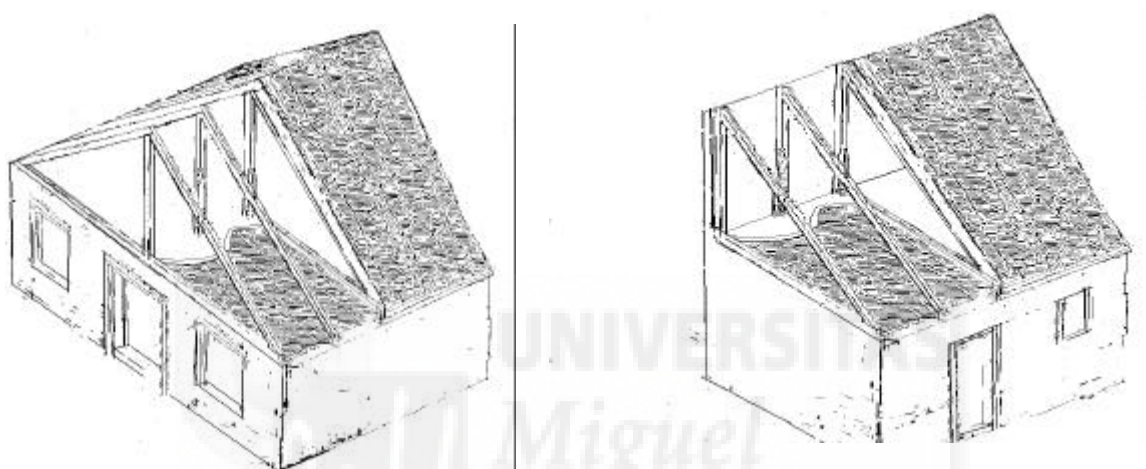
Croquis de disposición de caña común en las construcciones.
